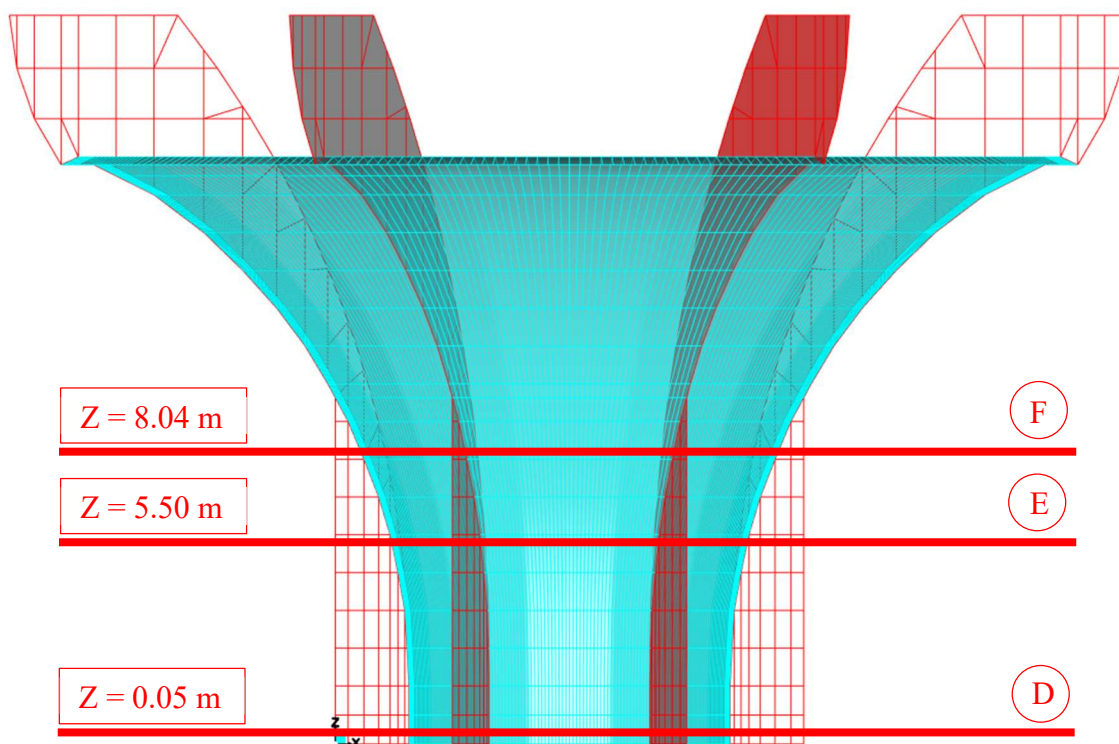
Posizione in altezza (asse Z) delle “section cut” delle sezioni rettangolari
